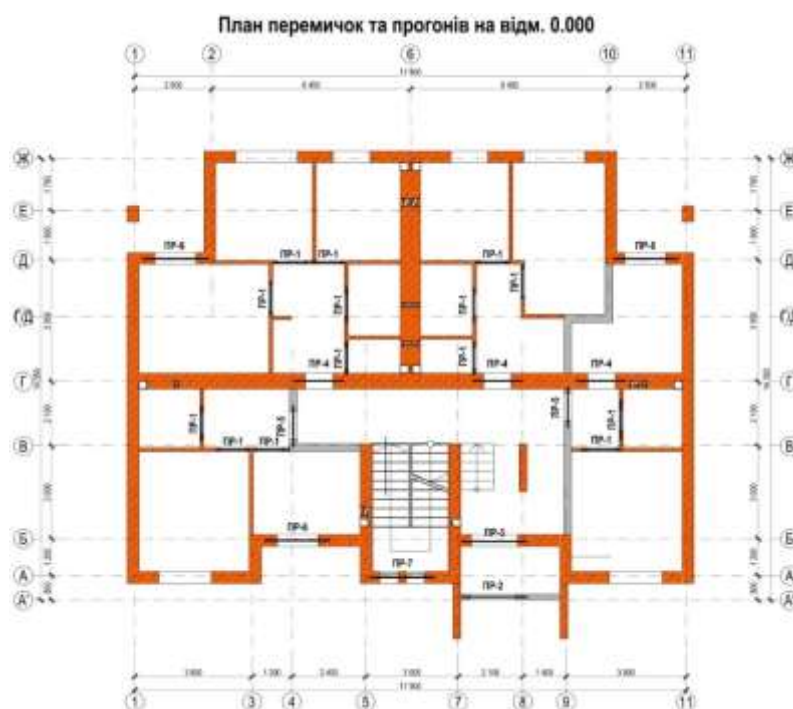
Влаштування перемичок на плані першого поверху секції
